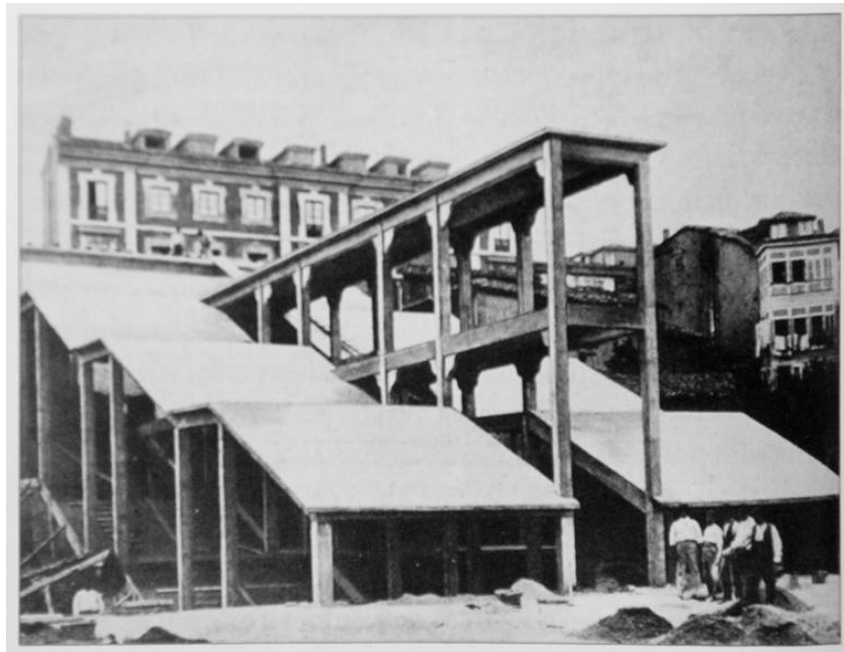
Escaleras y pasarela en la estación de Oviedo (Ferrocarril Vasco Asturiano) 1906. Compañía Anónima del Hormigón Armado de Sestao.
